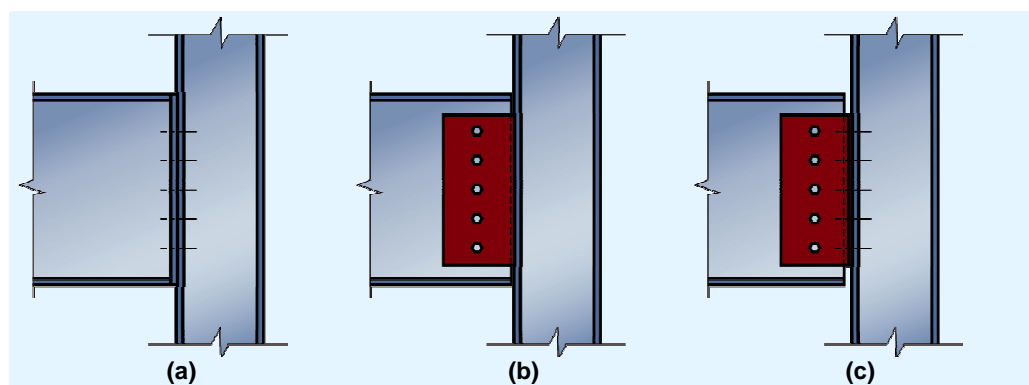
Uniones estándar viga – pilar. (a) Chapa de extremo (b) Acartelada (c) Con angulares dobles
